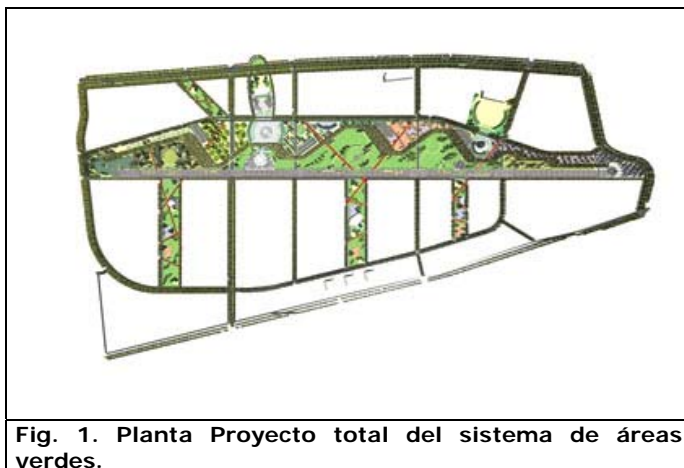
Planta Proyecto total del sistema de áreas verdes.
